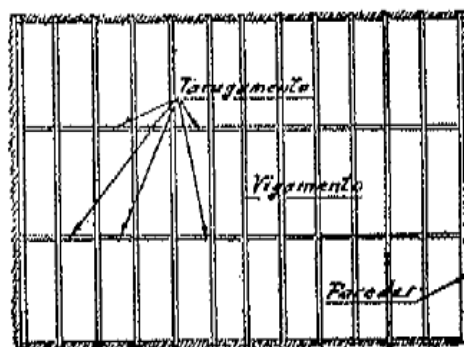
Planta de esteira vulgar ou vigamento de esteira [Costa, 1955].
